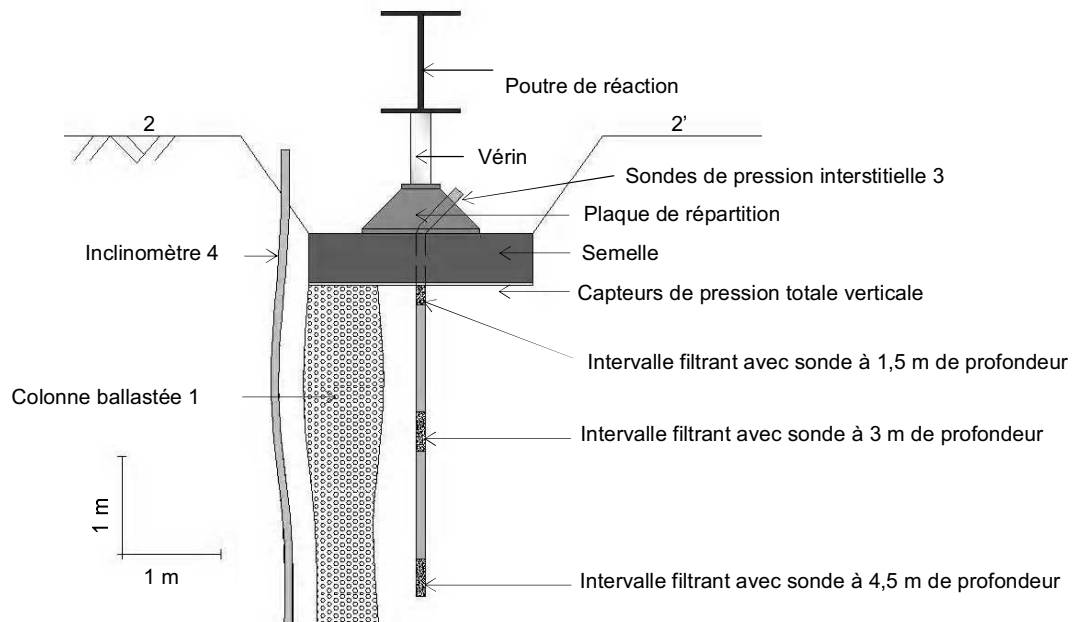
Coupe schématique de l'essai de chargement de la semelle sur les trois colonnes ballastées.
